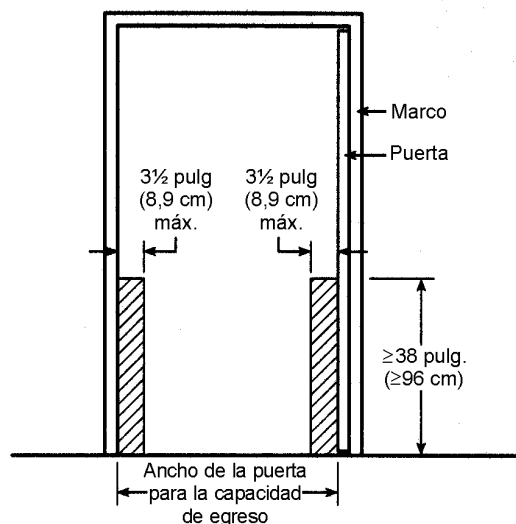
(a) Ancho libre mínimo.
